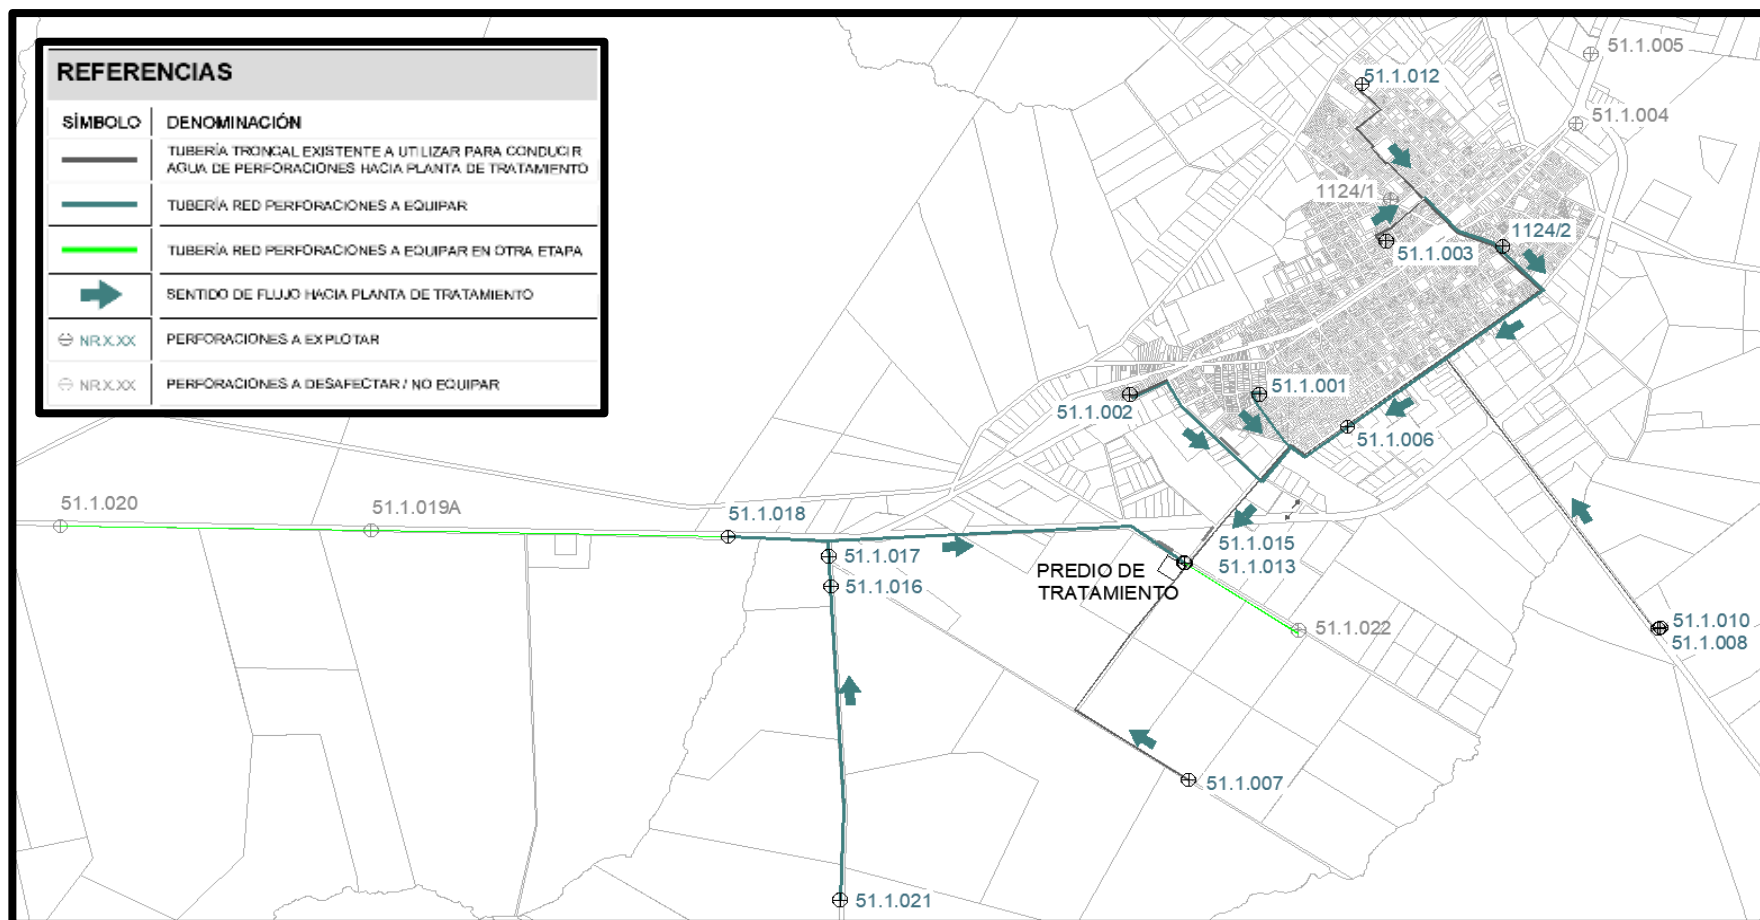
Perforaciones a equipar y redes de aducción a planta de tratamiento
